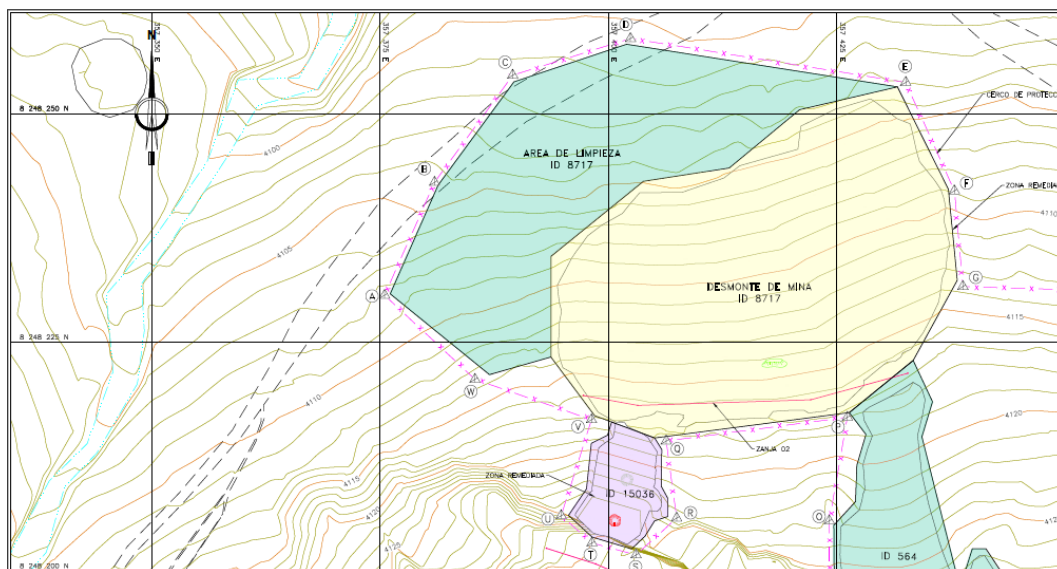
Vista en Planta desmonte de mina ID 8717
